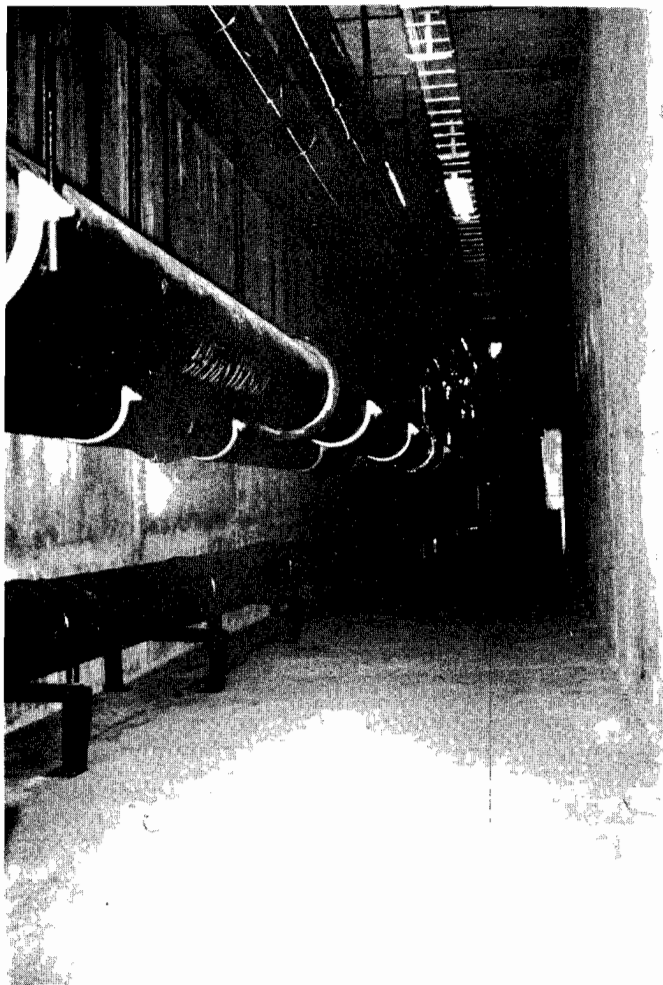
Tunnelinäkymä pienestä sivutunnelista.
